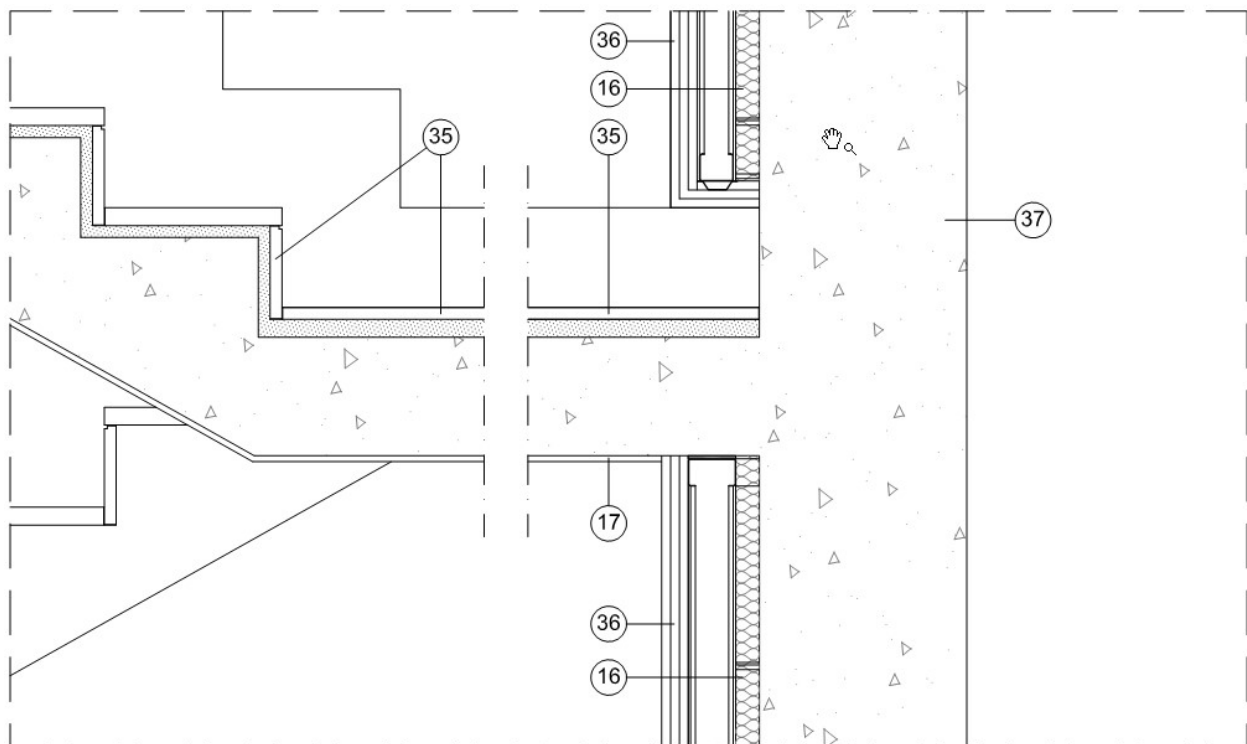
DETALLE 4. Plano D-1 "Detalles constructivos I".
